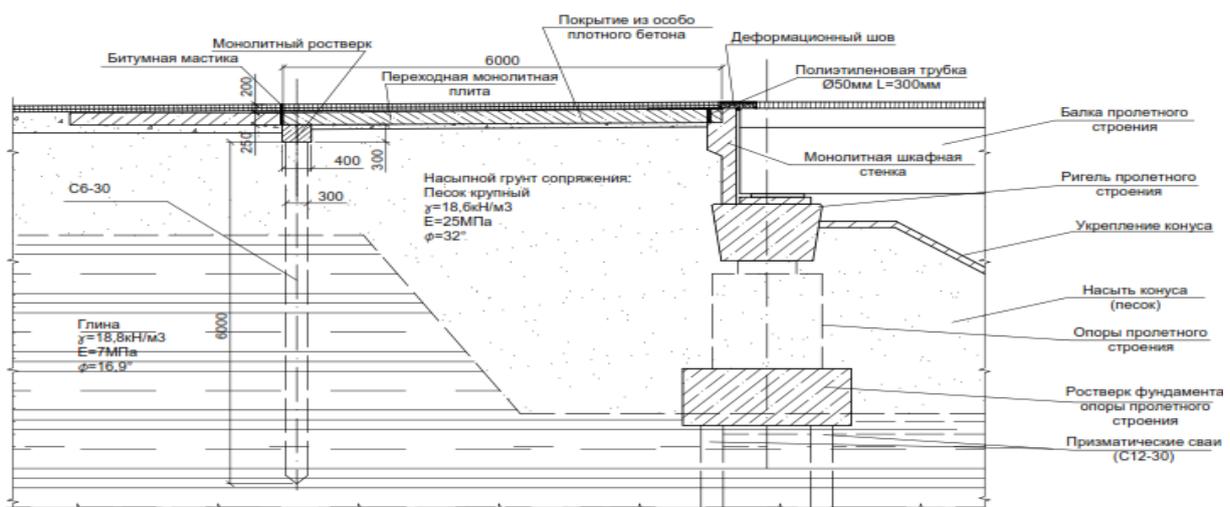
Конструкция устройства сопряжения на свайном фундаменте с монолитным ростверком
